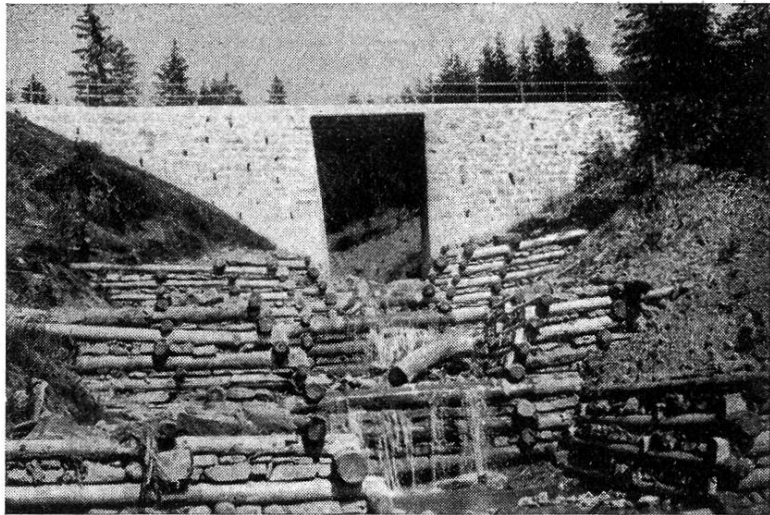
Pont de la Klewena, avec travaux de consolidation du lit du torrent.
